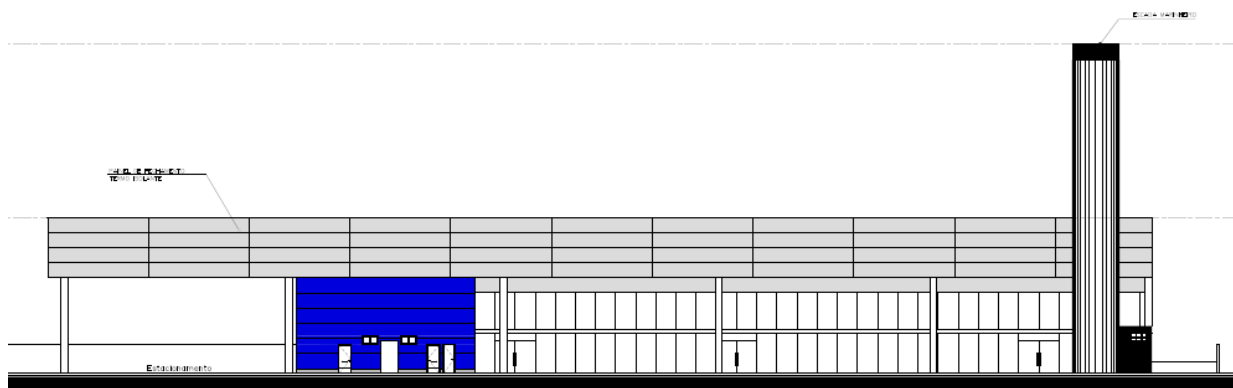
Vista da fachada frontal do futuro Costa Atacadão.
